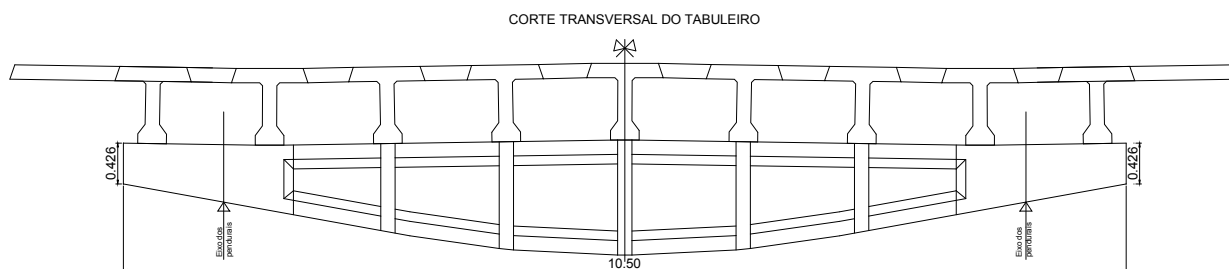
Corte transversal do tabuleiro pelo meio vão da longarina.
